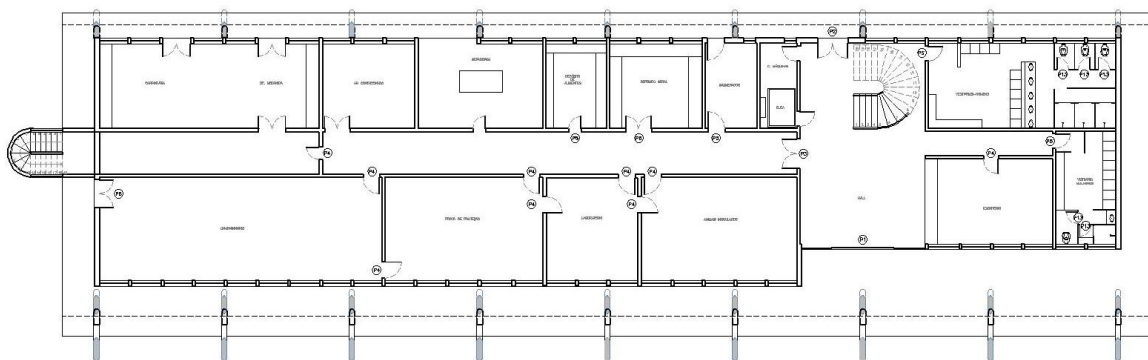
Redesenho da planta baixa do 1o pavimento, 1954. Fonte: DAD/COC/Fiocruz
